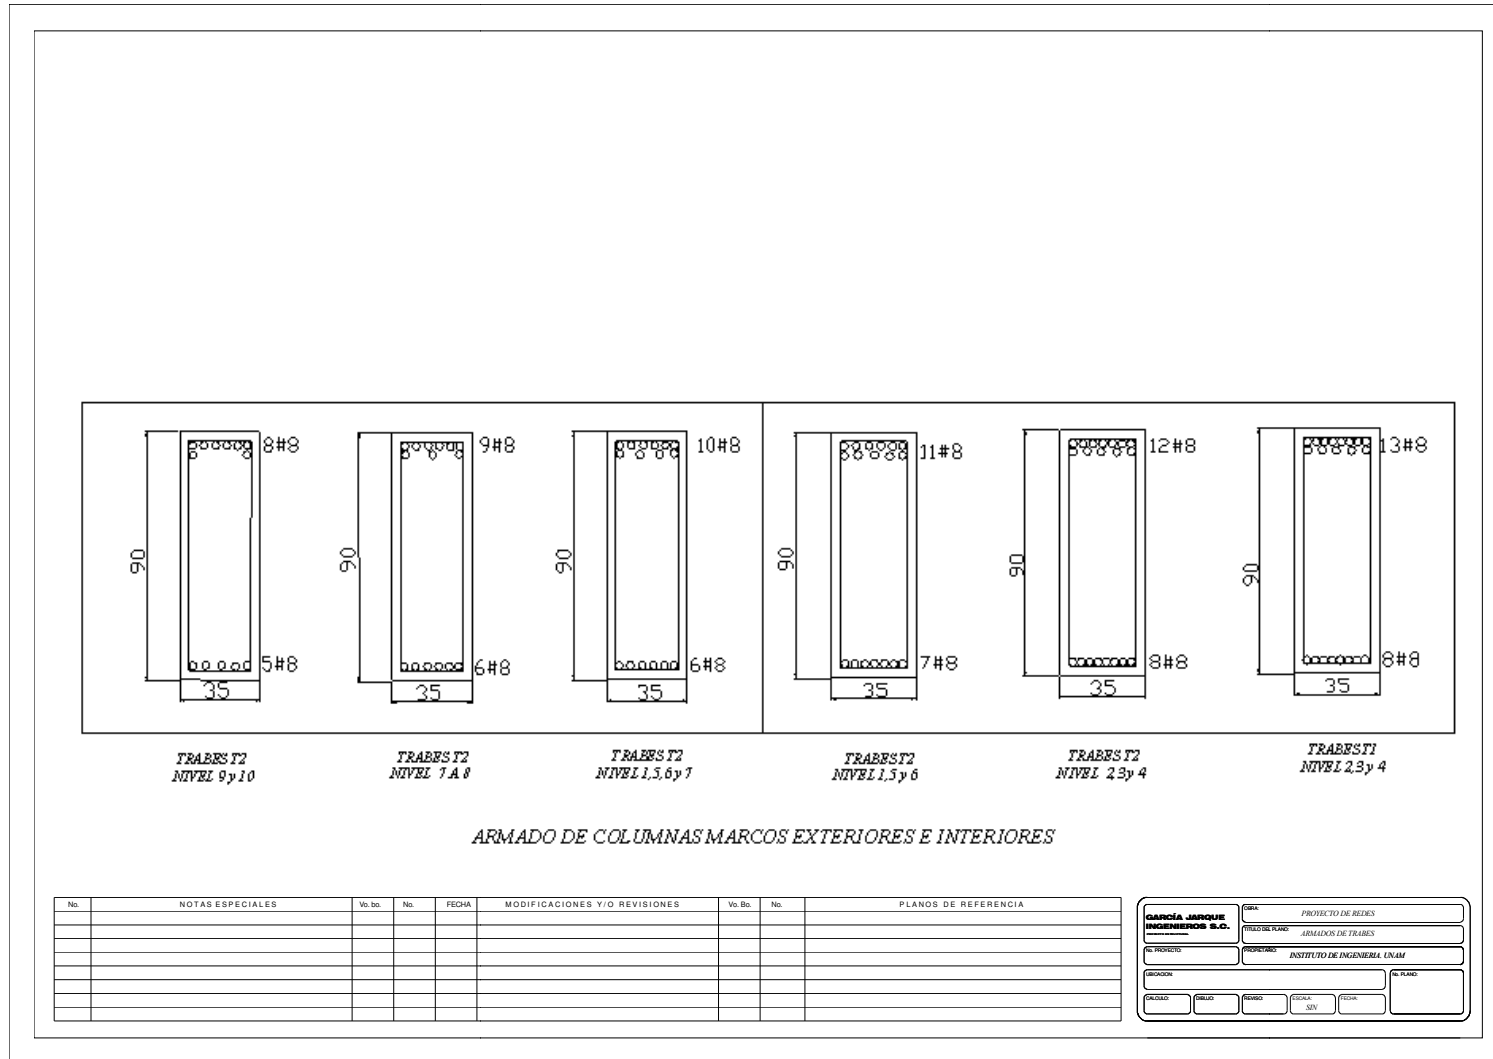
Secciones estructurales del edificio de 10 niveles
